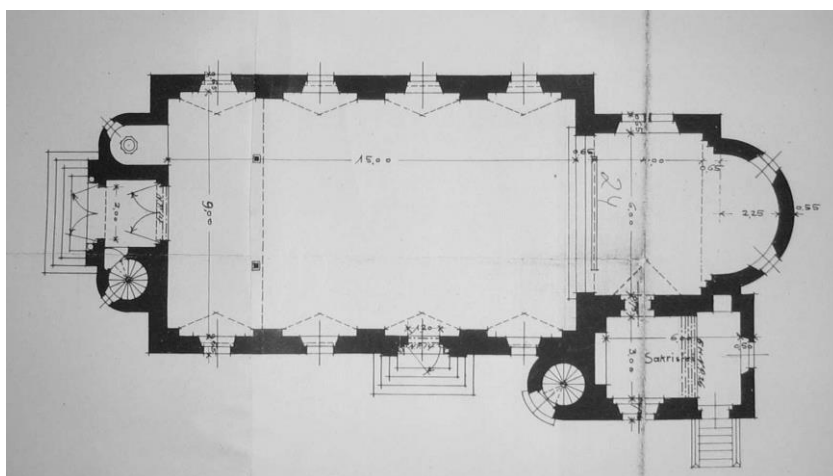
Grundriss, 10.01.1912
